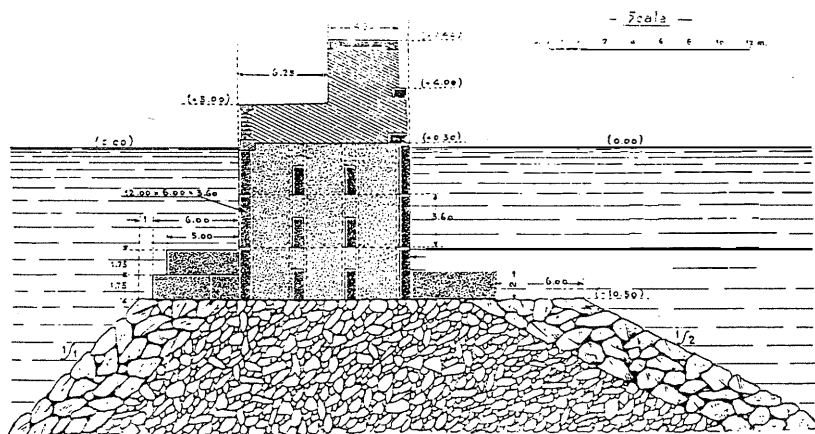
Diga del bacino della Lanterna, sezione trasversale.
